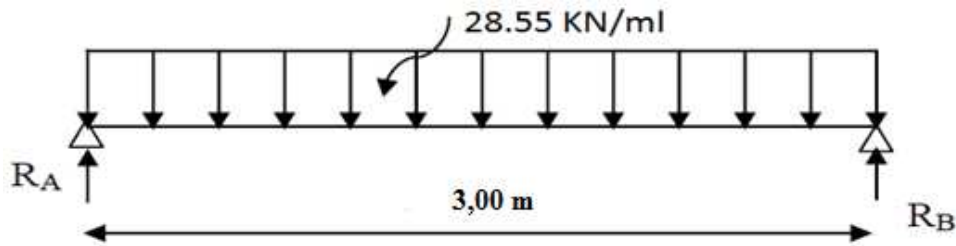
Schéma statique de la poutre palière l'ELU.
